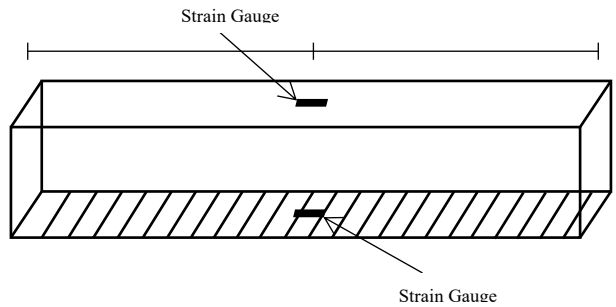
Tampak Bawah Pemasangan Lapisan CFRP pada Balok
